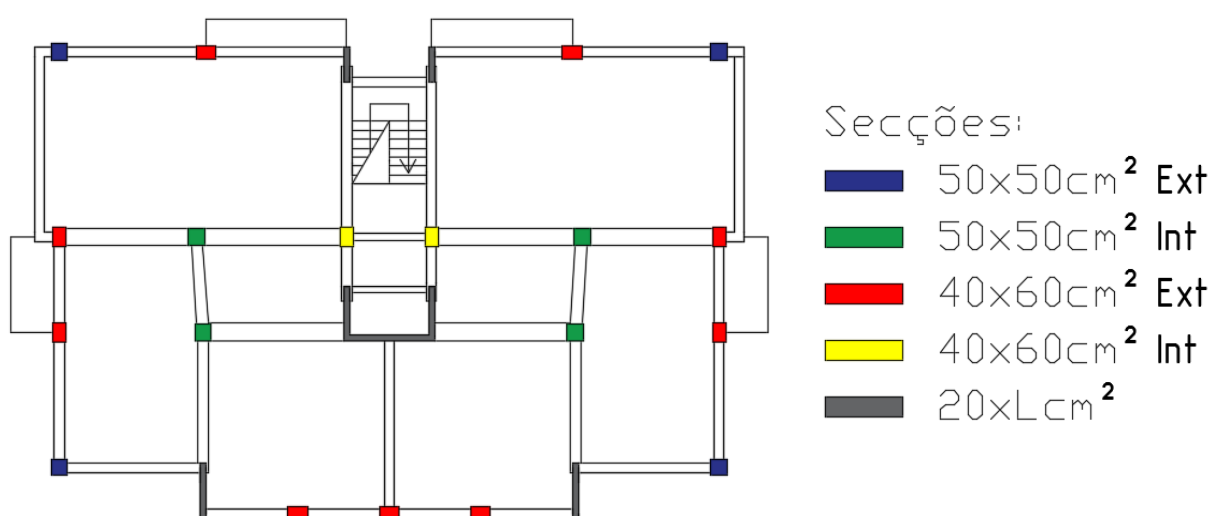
Nova distribuição de secções de pilares de betão armado
